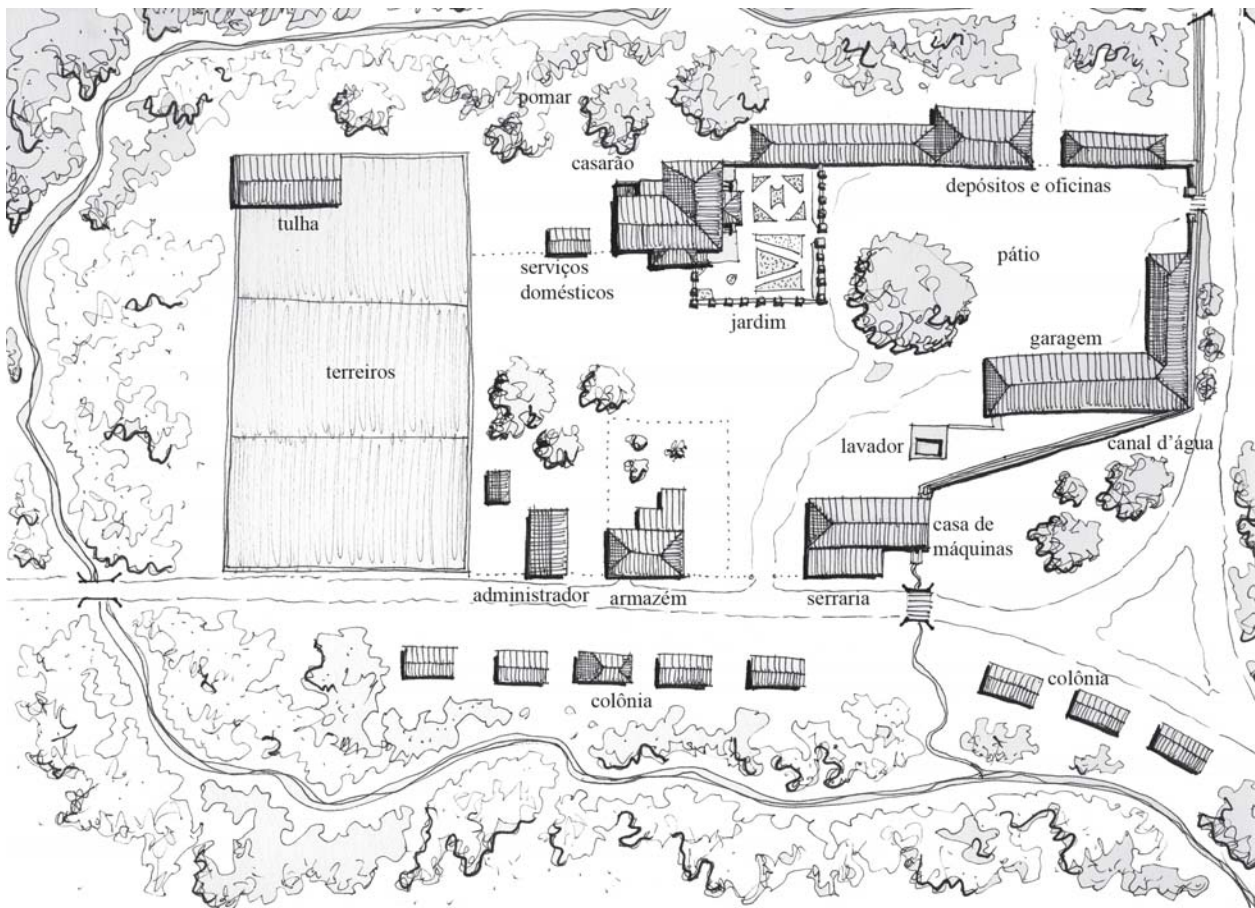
Implantação da fazenda Santana, São Carlos Desenho: M. Rosada.
